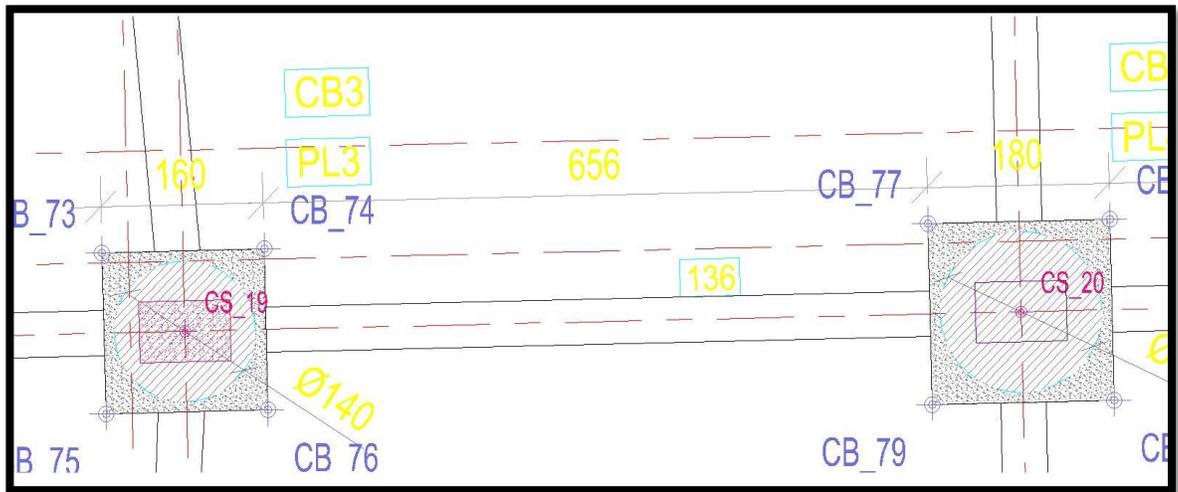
Detalle viga 136. (Fuente: Plano estructural MEISA)
